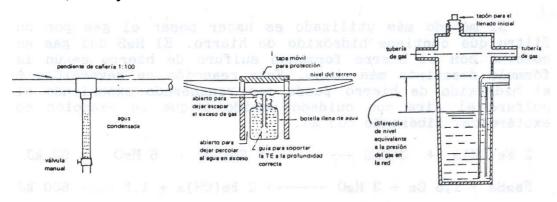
Tipos de drenaje: 1) Simple tipo "T"; 2) Automático subterráneo; 3) Automático tipo "sifón"
